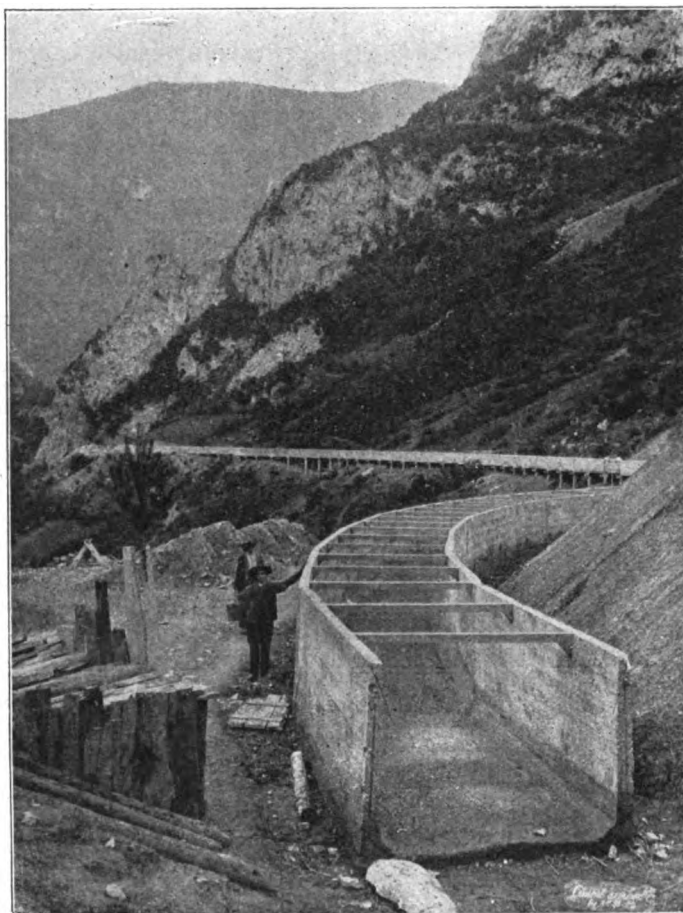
Canal d'amenée. Partie en ciment armé.
